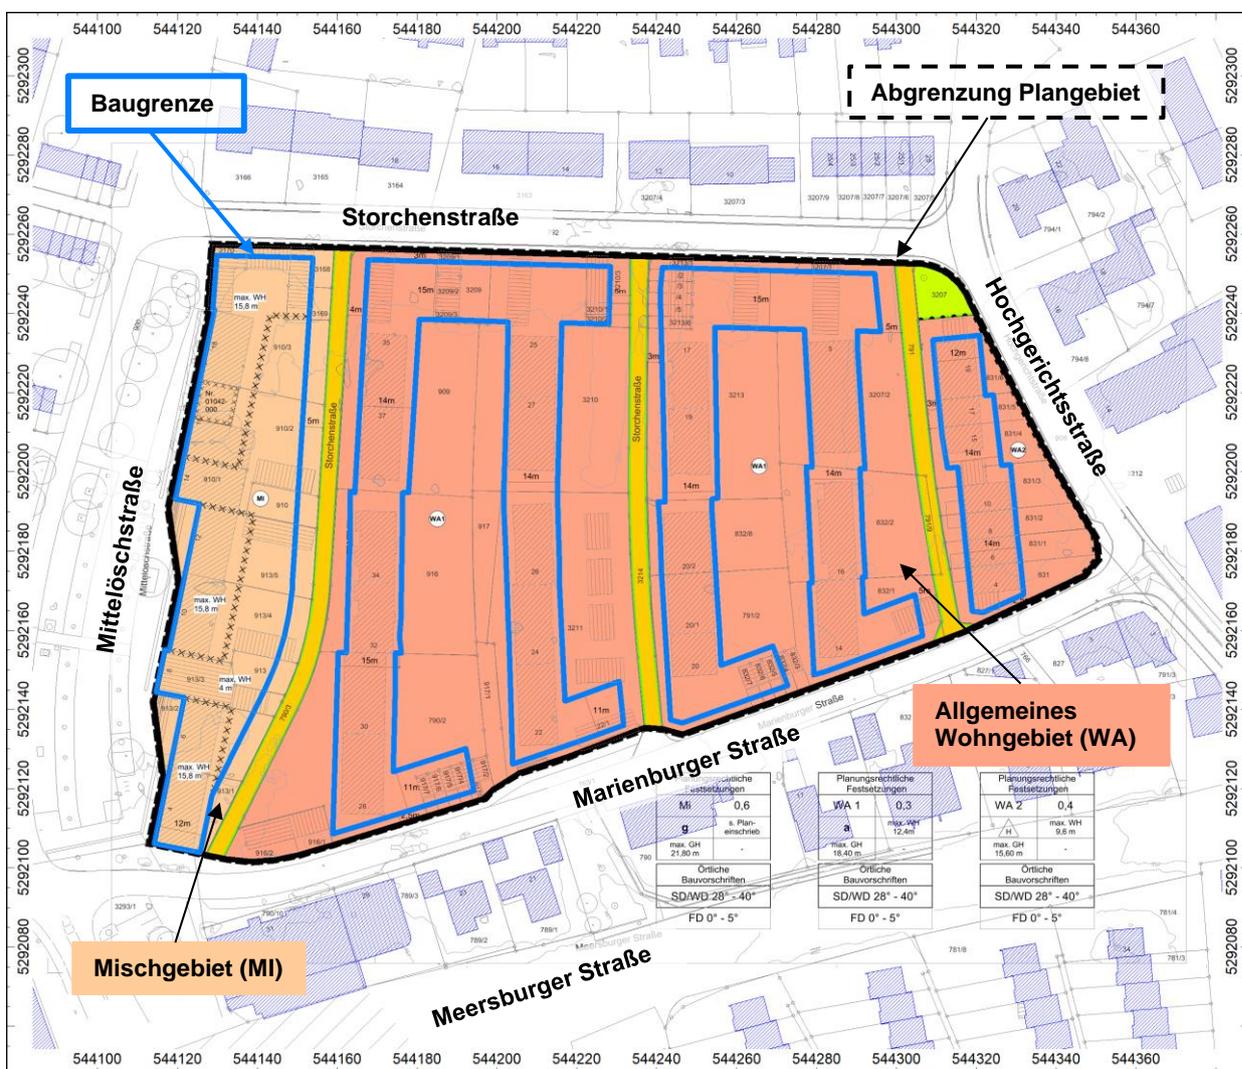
Planzeichnung zum Bebauungsplan „Zwischen Storchenstraße und Marienburger Straße“ /15/
